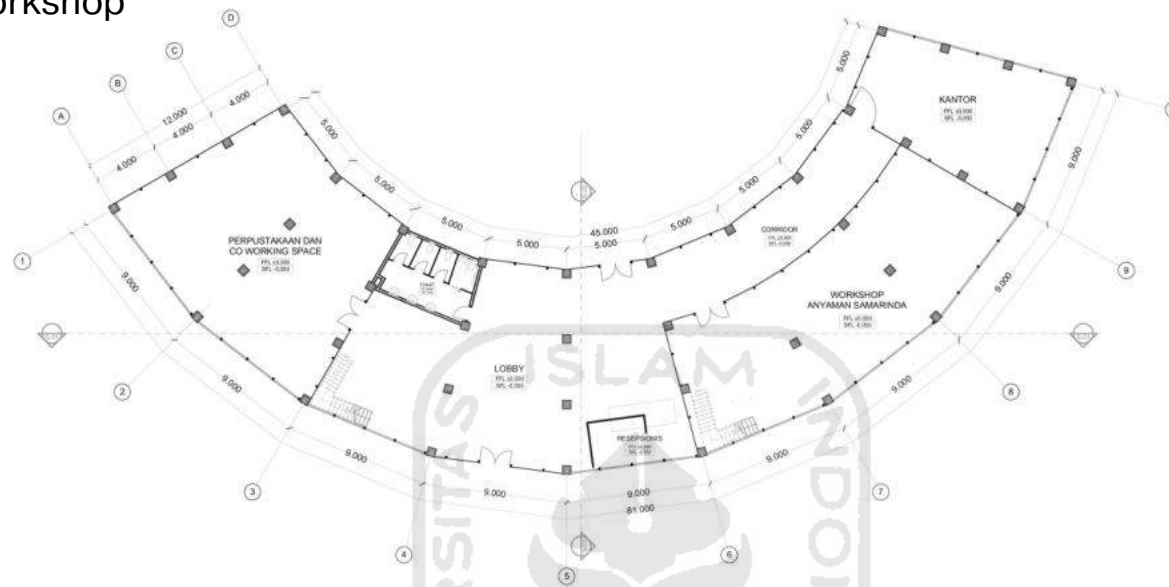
Site plan (Sumber: Penulis, 2021)
